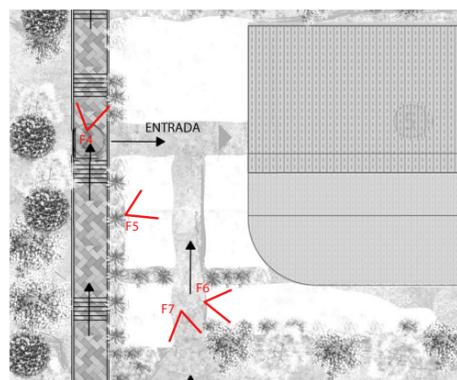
PLANTA DE VISTAS EXTERIORES
